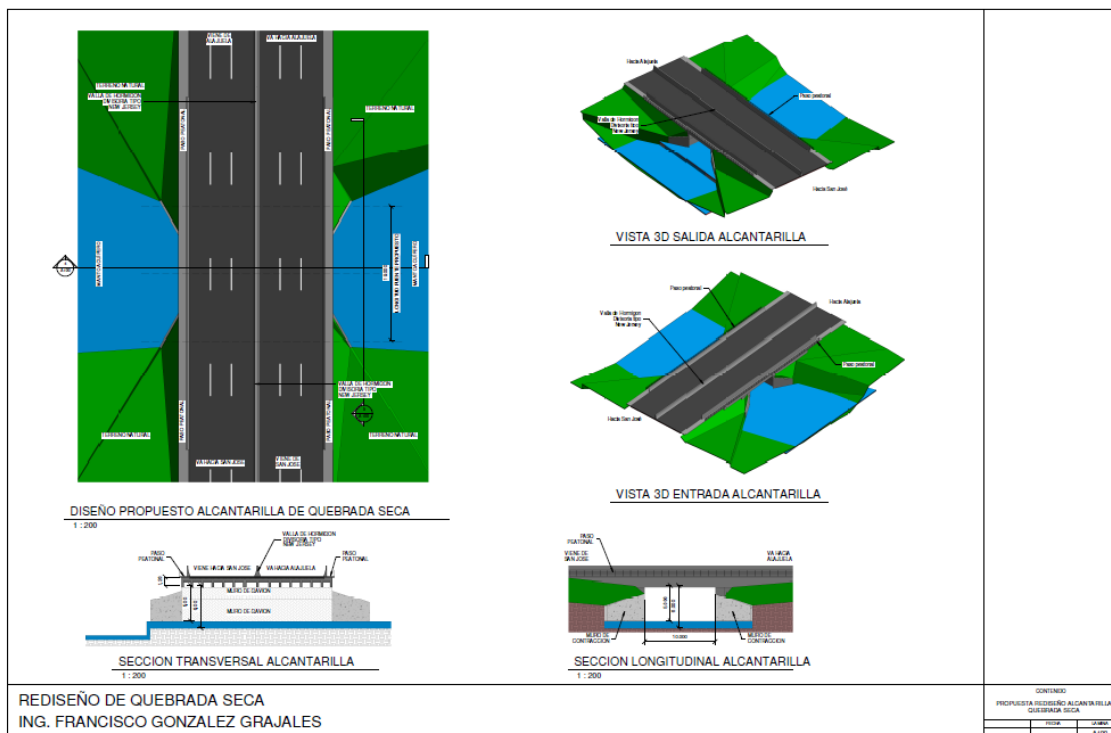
Plano de la alcantarilla sugerida, modelo preliminar.
